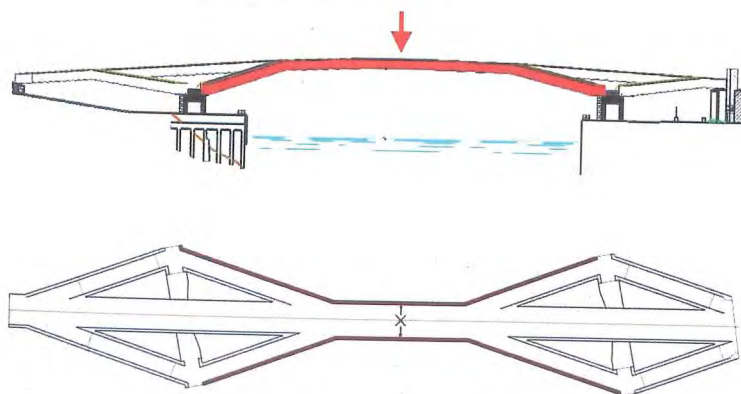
Poutres extérieures et mécanisme de flexion /
